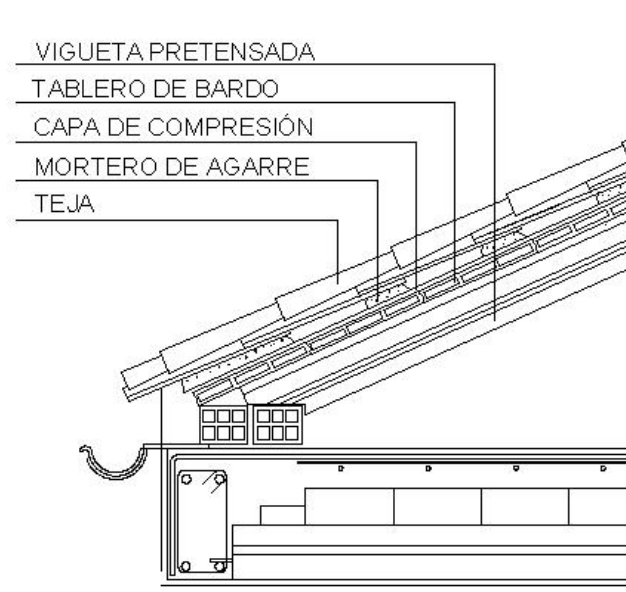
Detalle cubierta inclinada apoyada mediante vigueta pretensada
